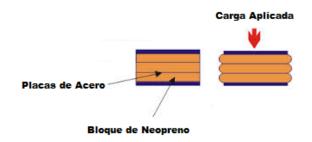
HINCHAMIENTO DEL APOYO ELASTOMERICO CON PLACAS DE ACERO
